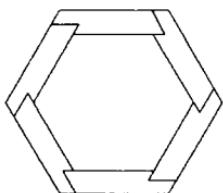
单层砌筑平面示意图 图 4.4.5-2 交错砌筑平面示意图
